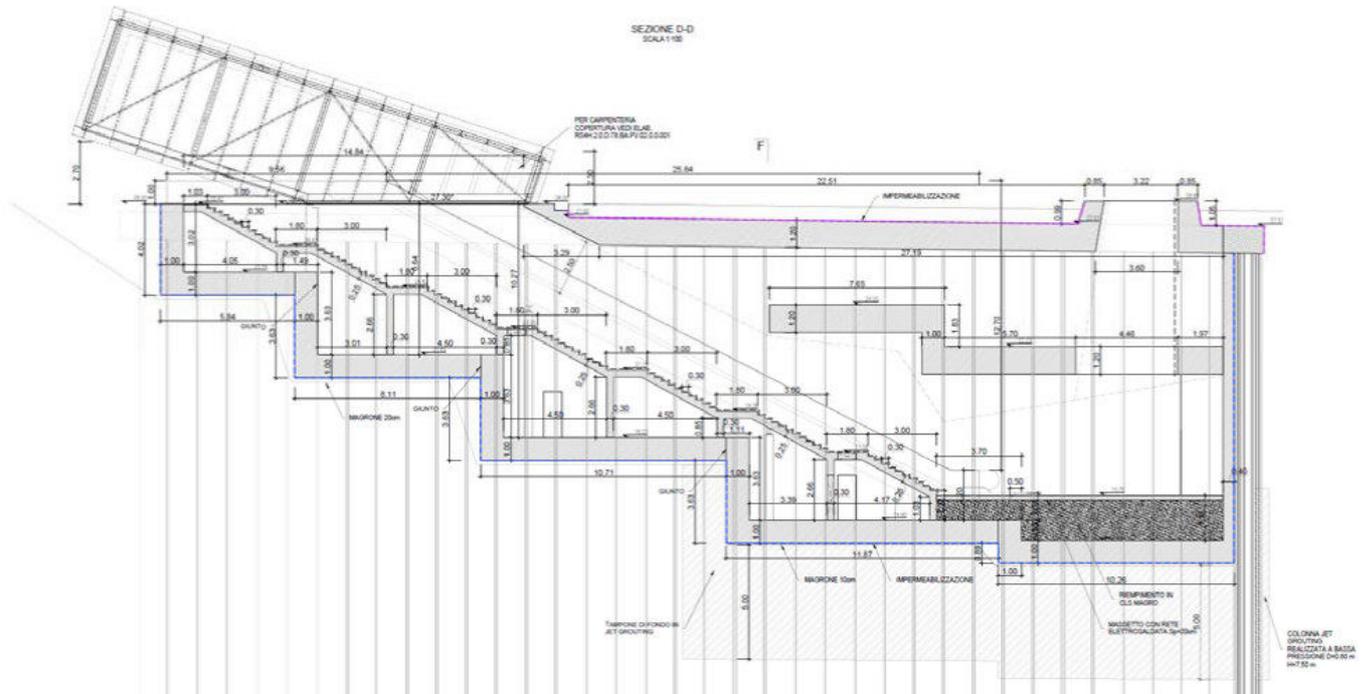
Sezione longitudinale del blocco scale mobili e fisse
